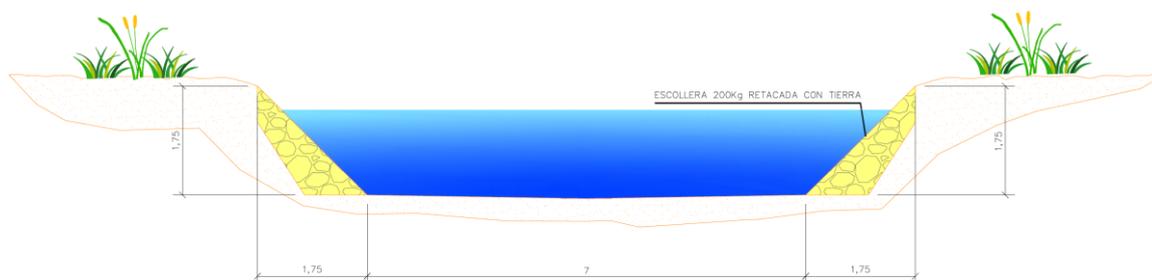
Sección tipo propuesta para el arroyo El Búho.
